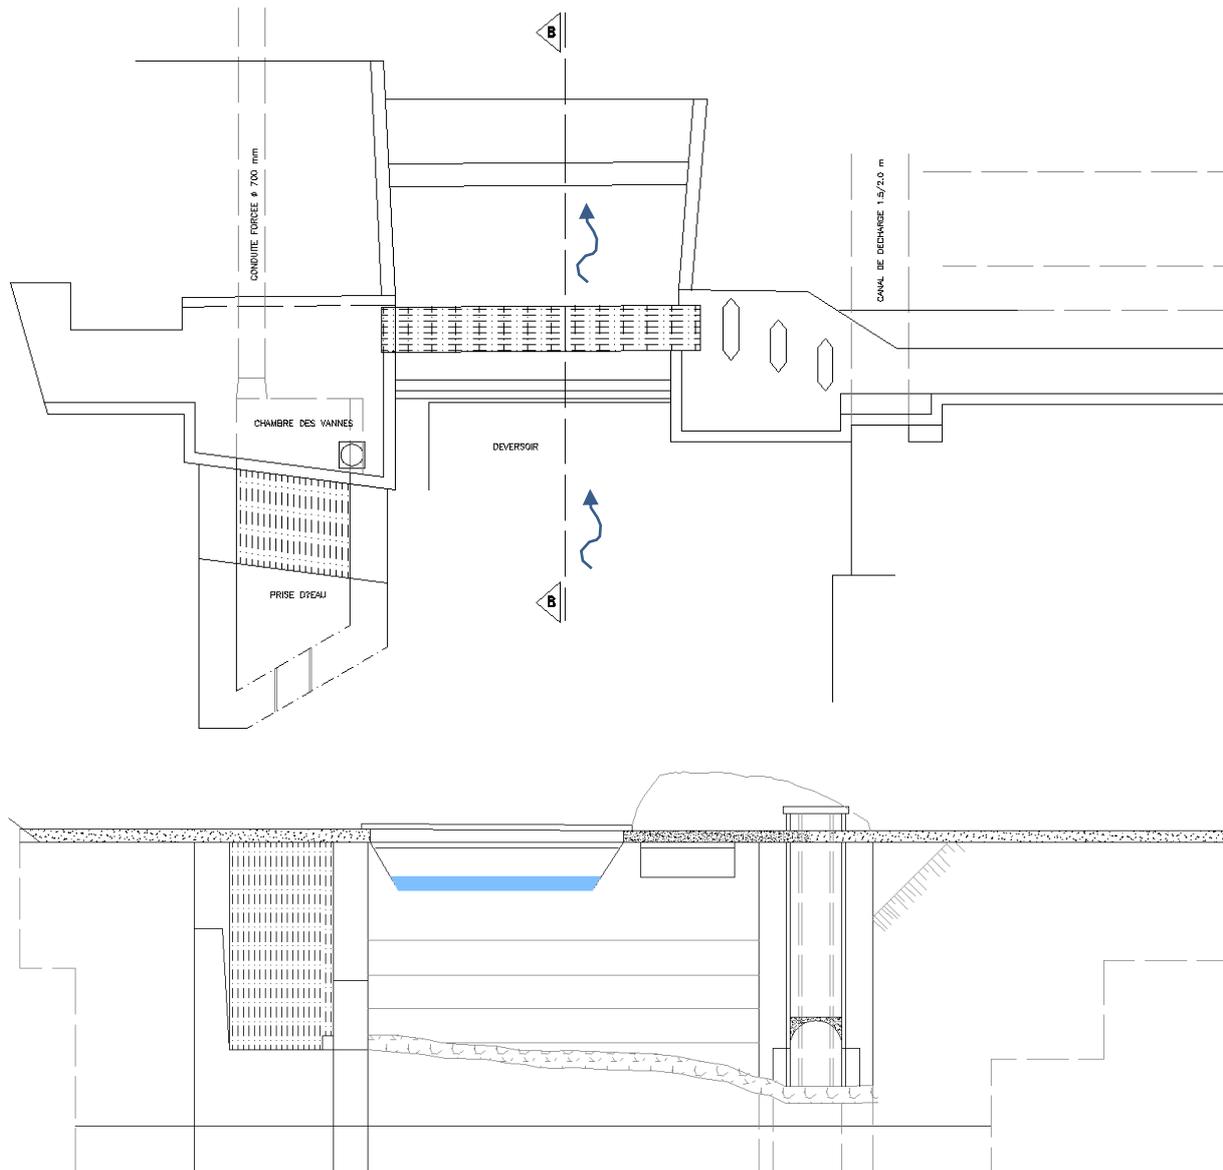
Vue en situation de la prise d'eau de Blanches Fontaines en haut et profil en long B-B' correspondant au droit du déversoir en bas (Source : Pierre-Alain Bourquard).
